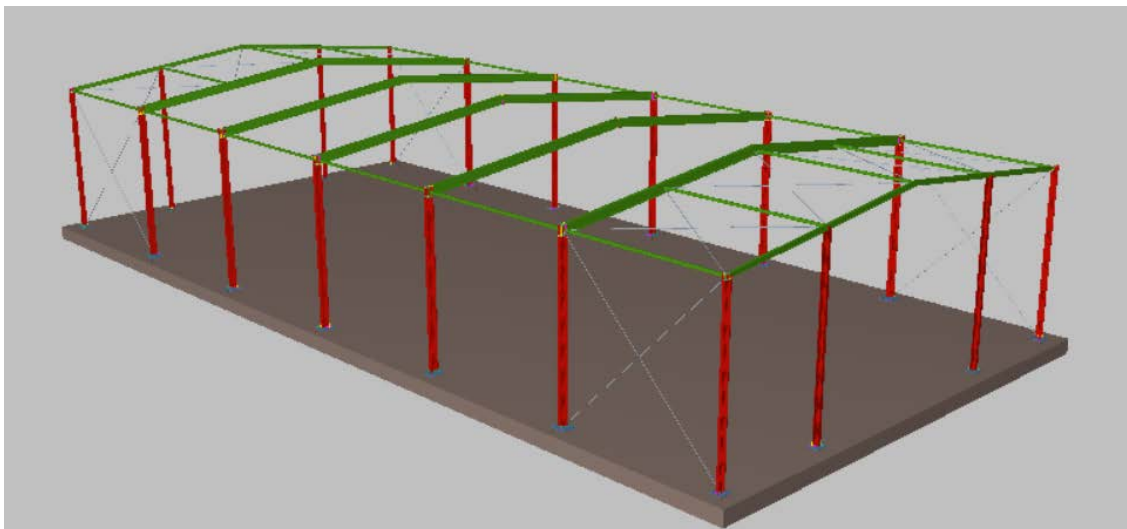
Vista 3D losa de cimentación. Fuente: CYPECAD
